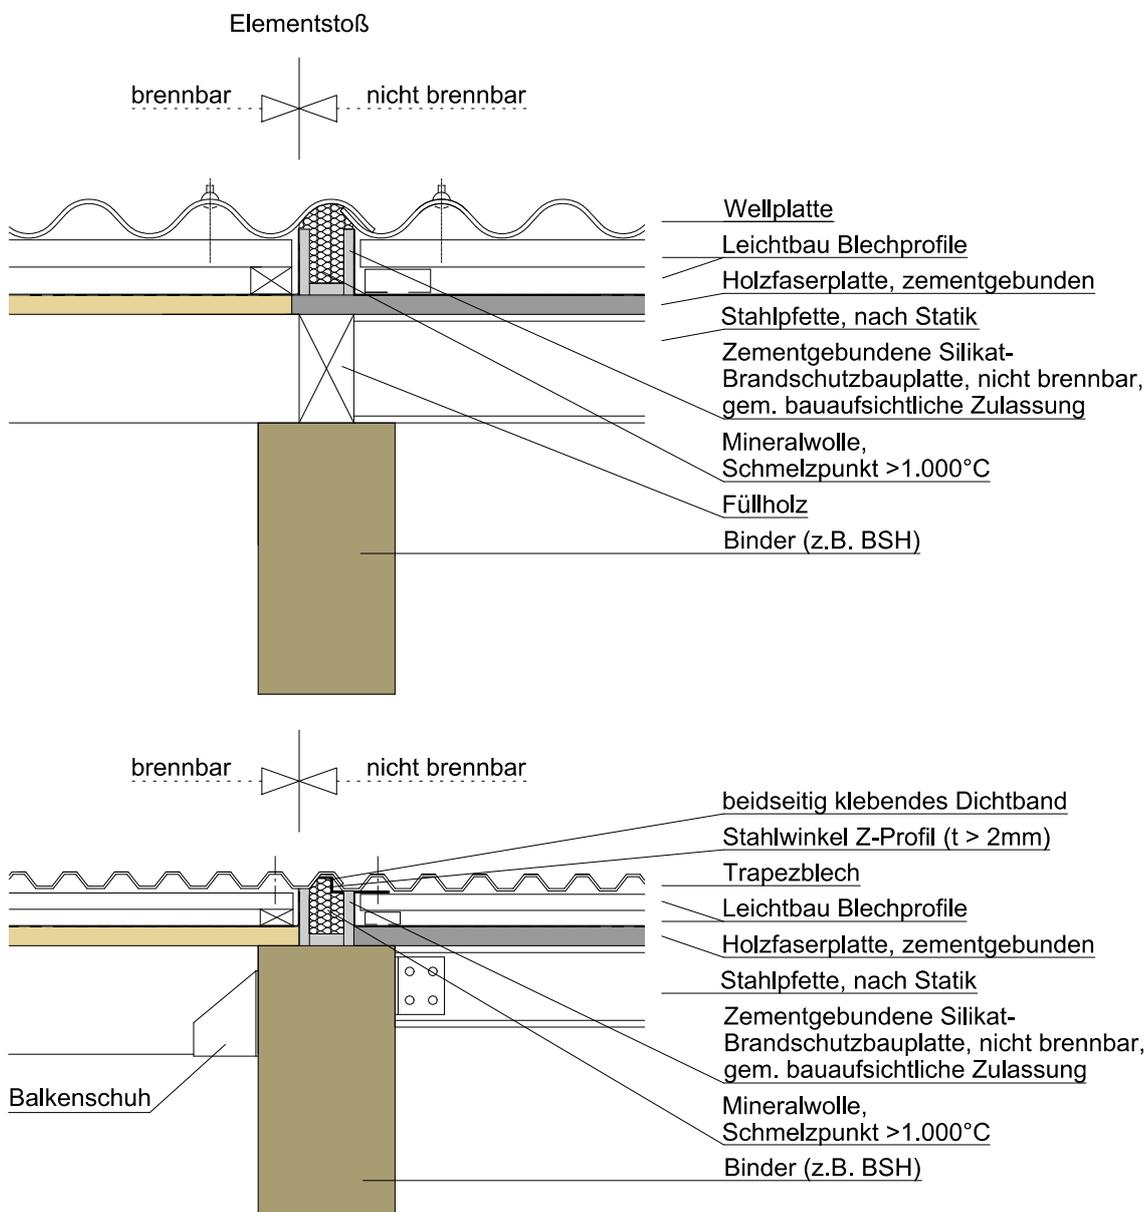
Schnitt durch den Binder / Dachaufbau im Bereich des „nicht brennbaren Binderfeldes“ mit unterschiedlichen Aufbauten
